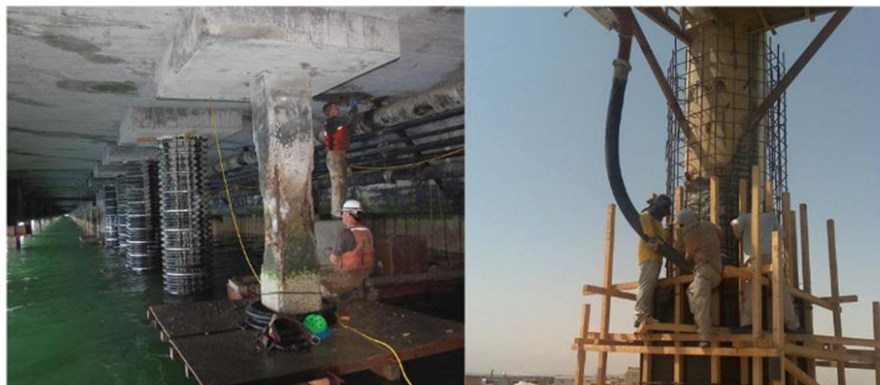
Encamisamento de pilares com betão armado (Santos, 2008).
